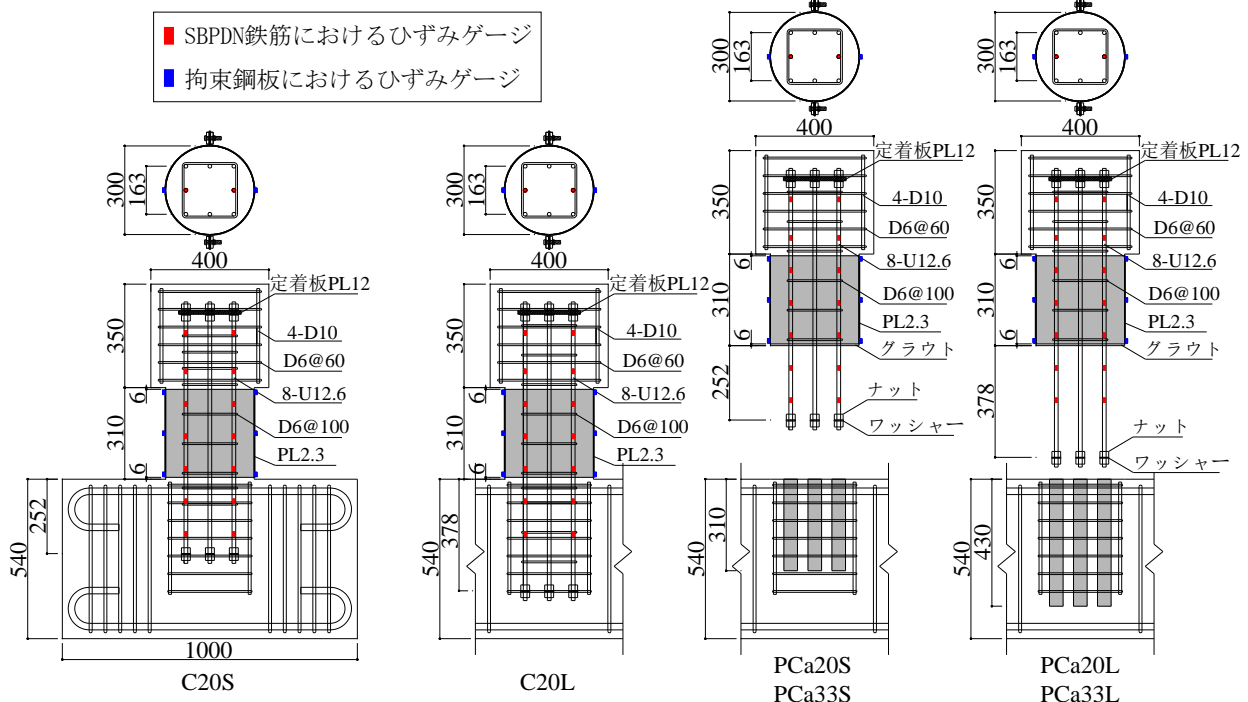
試験体の寸法及び配筋詳細(寸法の単位mm)
